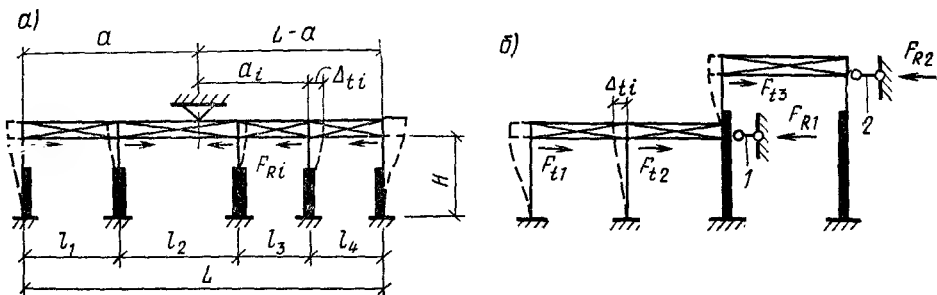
Расчетные схемы рам при определении температурных перемещений
